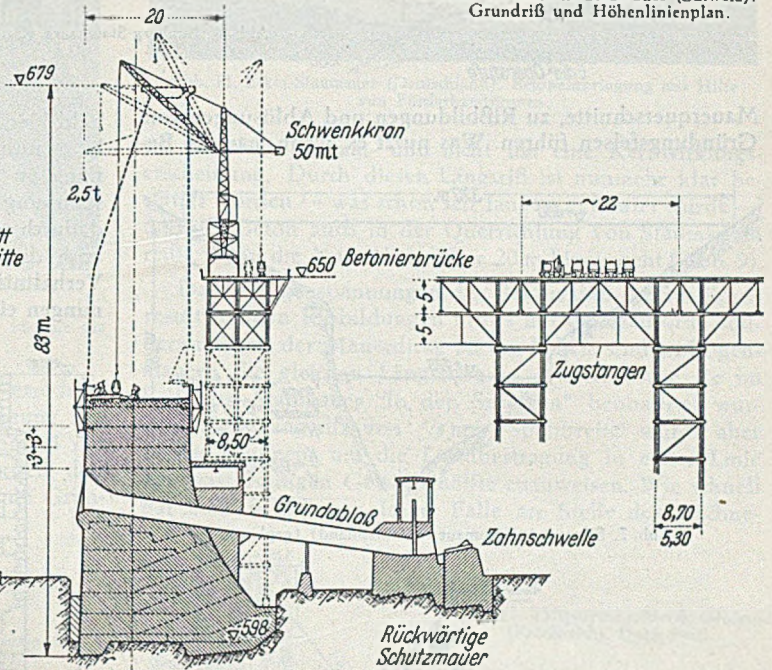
Rossens-Staumauer (Schweiz). Querschnitt in Talmitte mit Vorsperre, Betonierbrücke und Einbringekranen.
